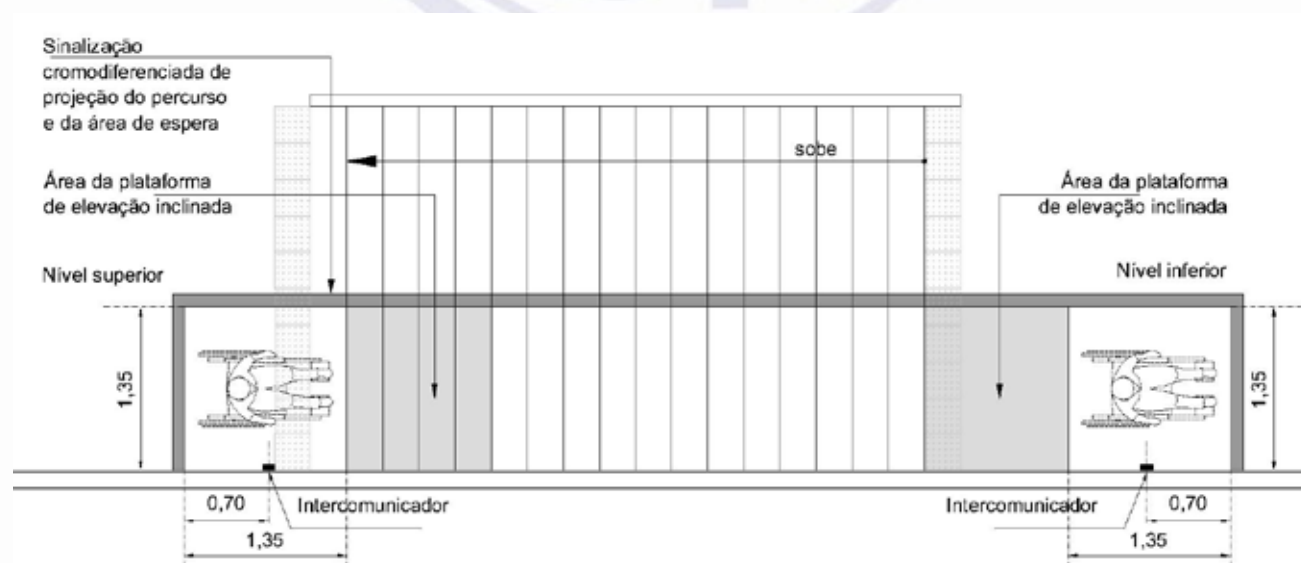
Sinalização de piso junto à plataforma de elevação inclinada – Vista superior
